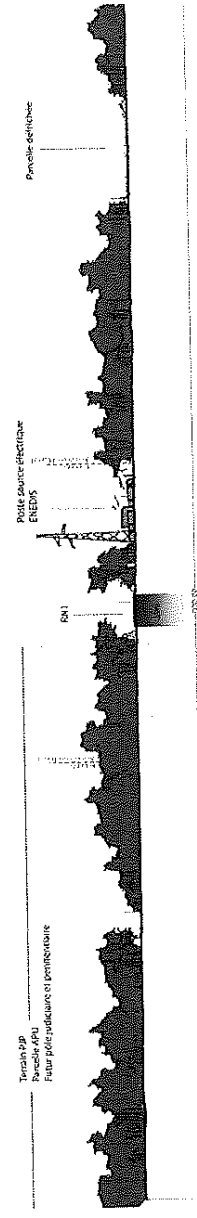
Coupe paysagère sur la RN1 au droit du site. Source: SEURA, 2019. Plan Guide d'aménagement, périmètre OIN Margot
